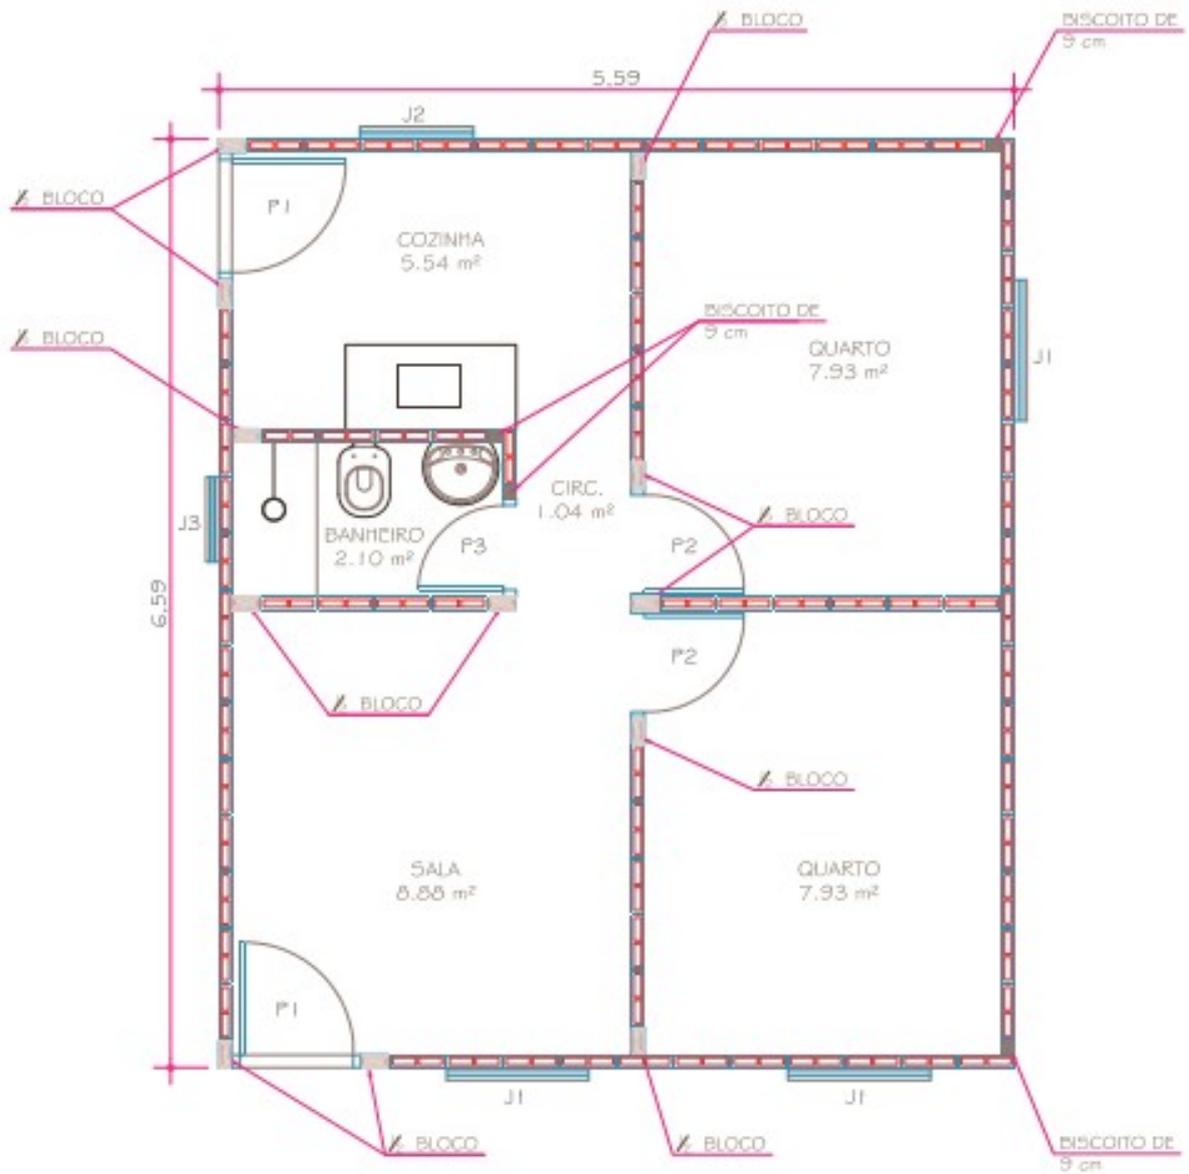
Planta baixa da modulação 1ª fiada.Fonte: Cadernos Caixa – GIDUR/VT, 2006.
